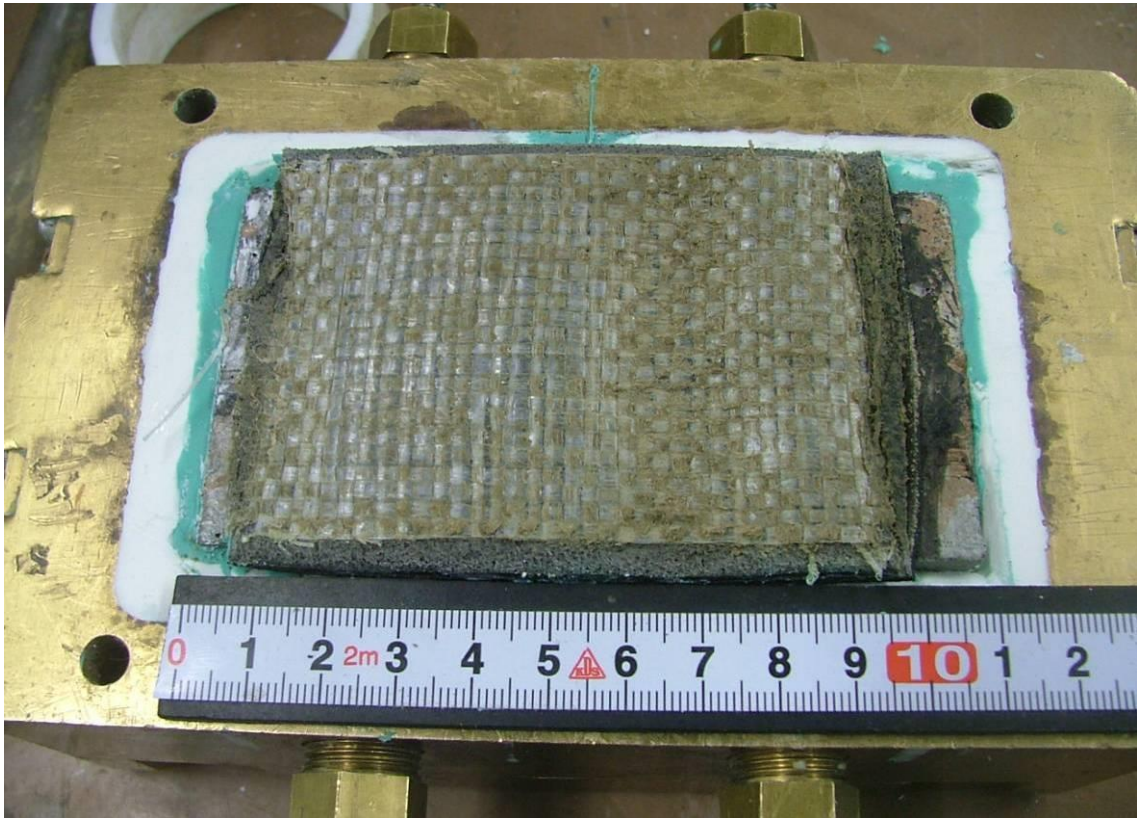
繰返し載荷試験 試験後の供試体状況 ケース 1-7 (保護層表面)
